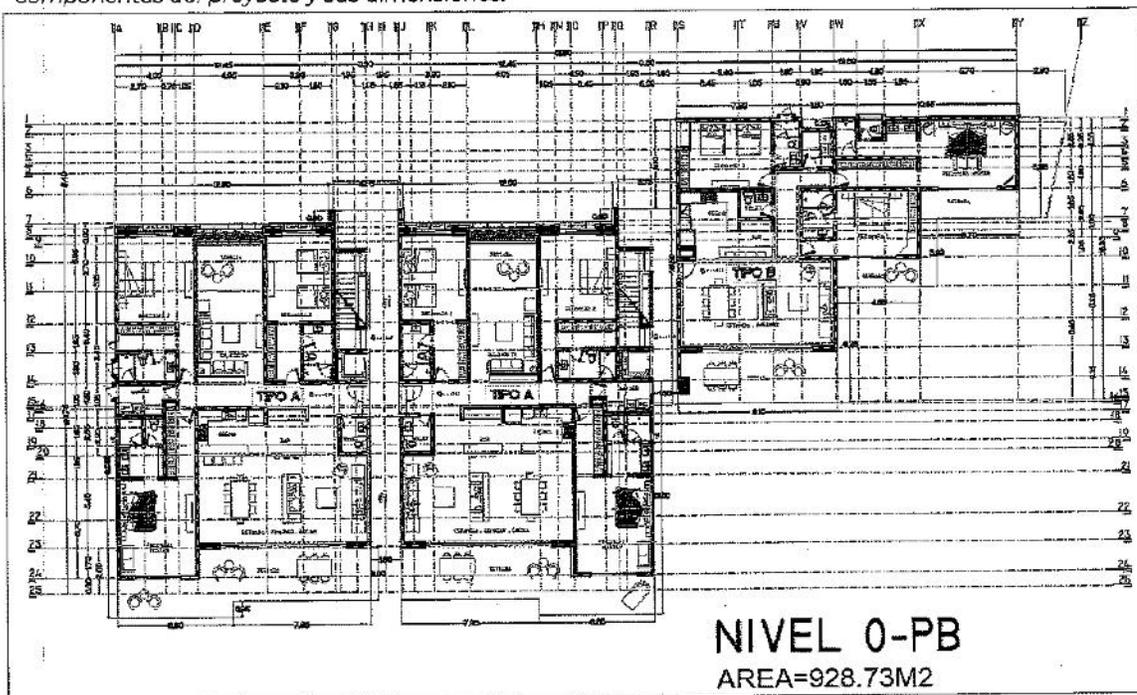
Se muestran los componentes y dimensiones del edificio en Planta Baja.
